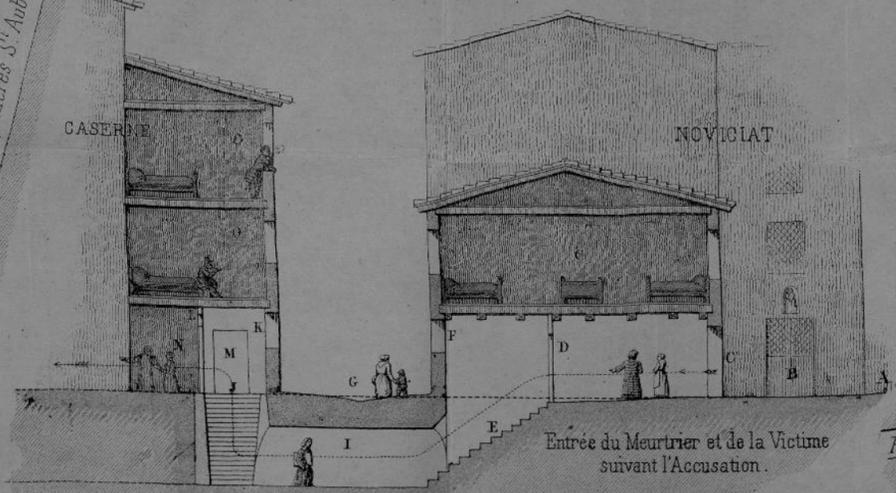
COUPE SUIVANT LA LIGNE E E E' (Plan Général) DU TUNNEL qui sert de Passage du Noviciat au Pensionnat et au Jardin.
